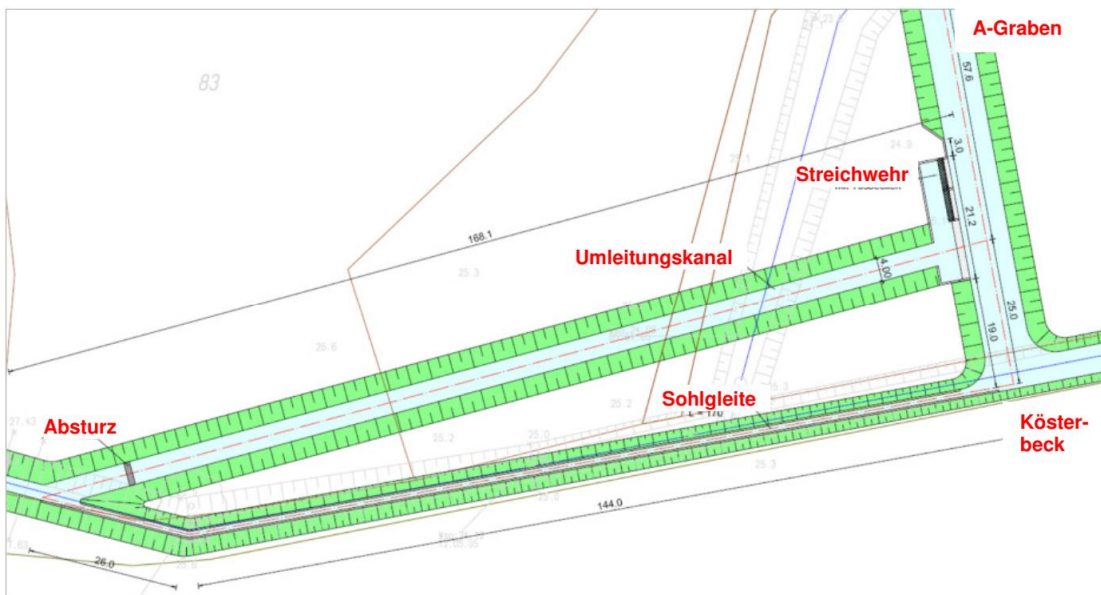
Variante 1 - Detailansicht Wehrbauwerk
